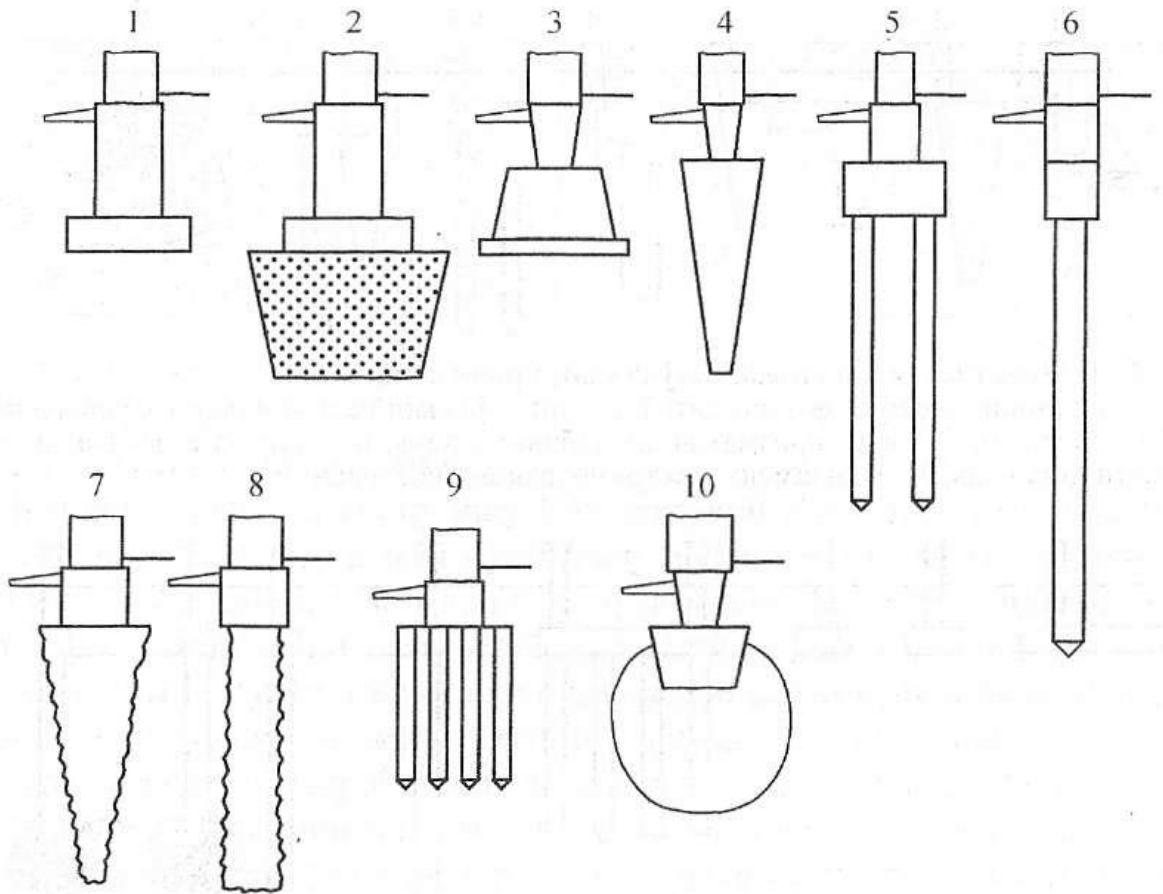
Варіанти фундаментів під несучі стіни безкаркасних будівель:
